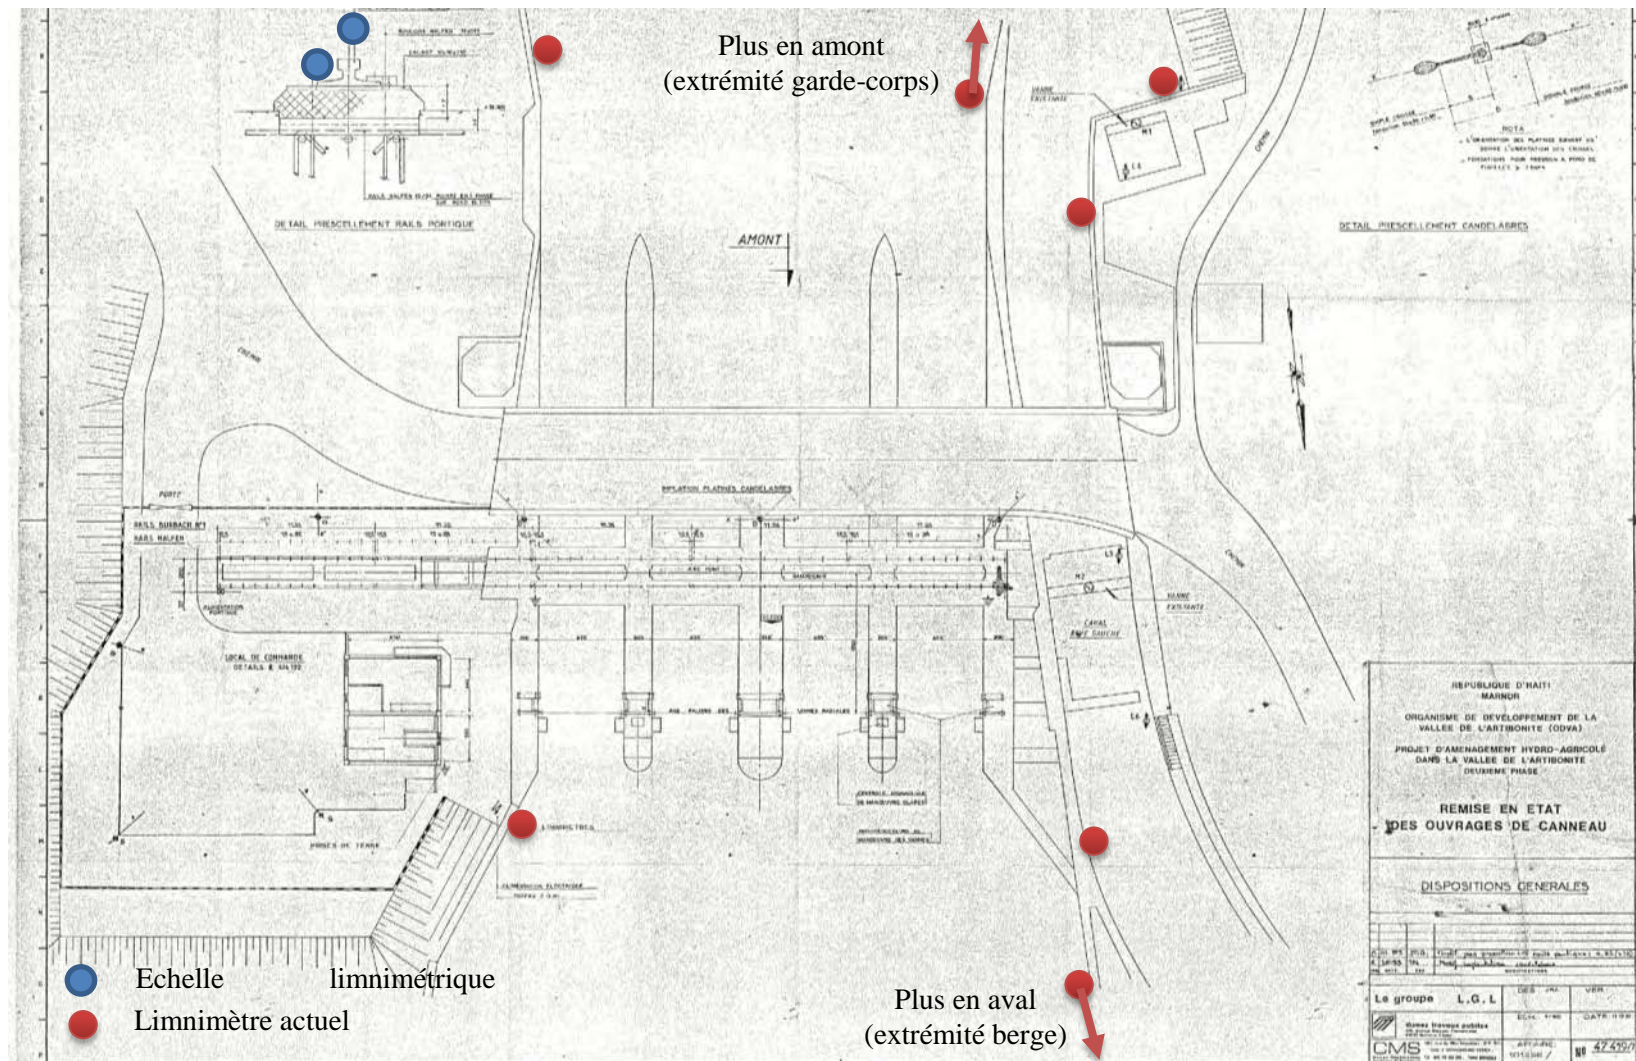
Barrage de Canneau - Plan de localisation des limnimètres (fond de plan LGL-DUMÉZ-CMS n°47 419-1 de 1988)
